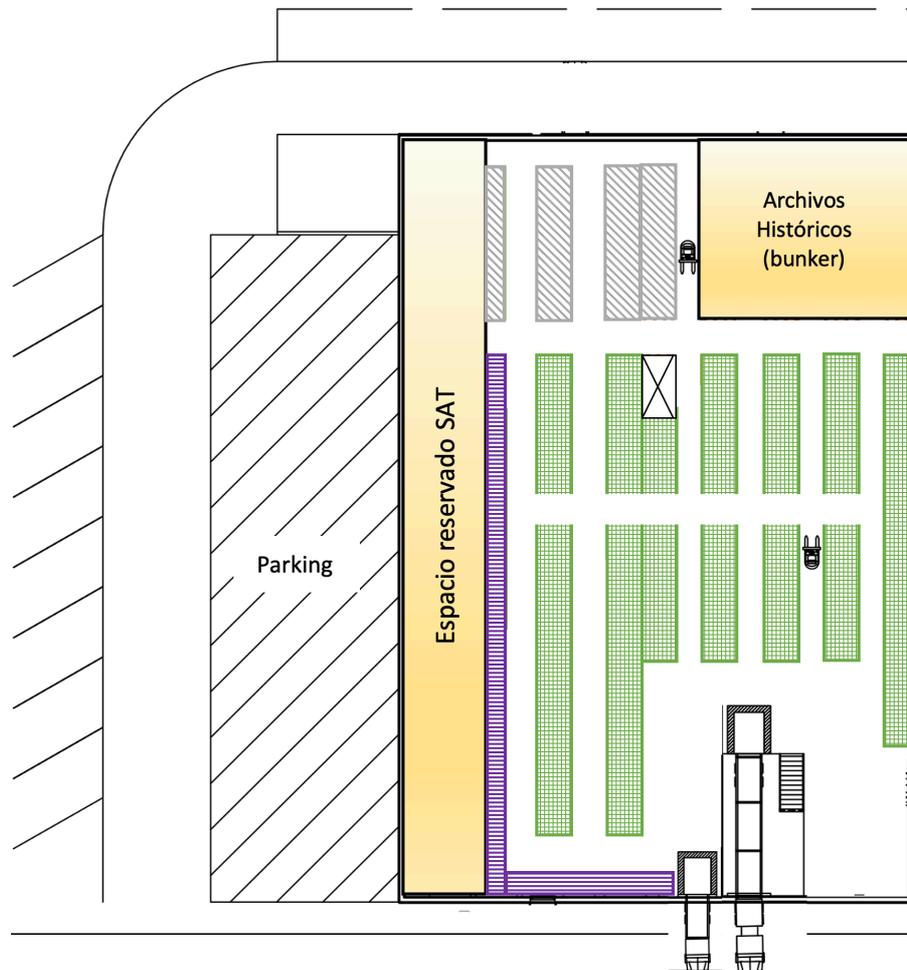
Layout planta sótano. Fuente: Elaboración propia.
